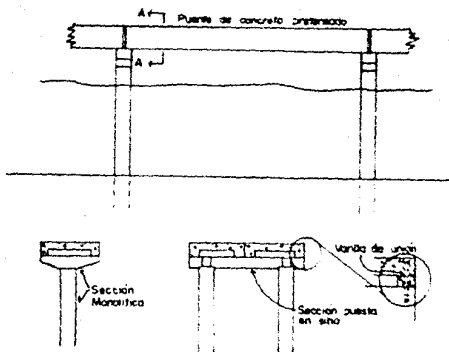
Sección de un muelle fijo de concreto pretensado y detalles de colocación.
